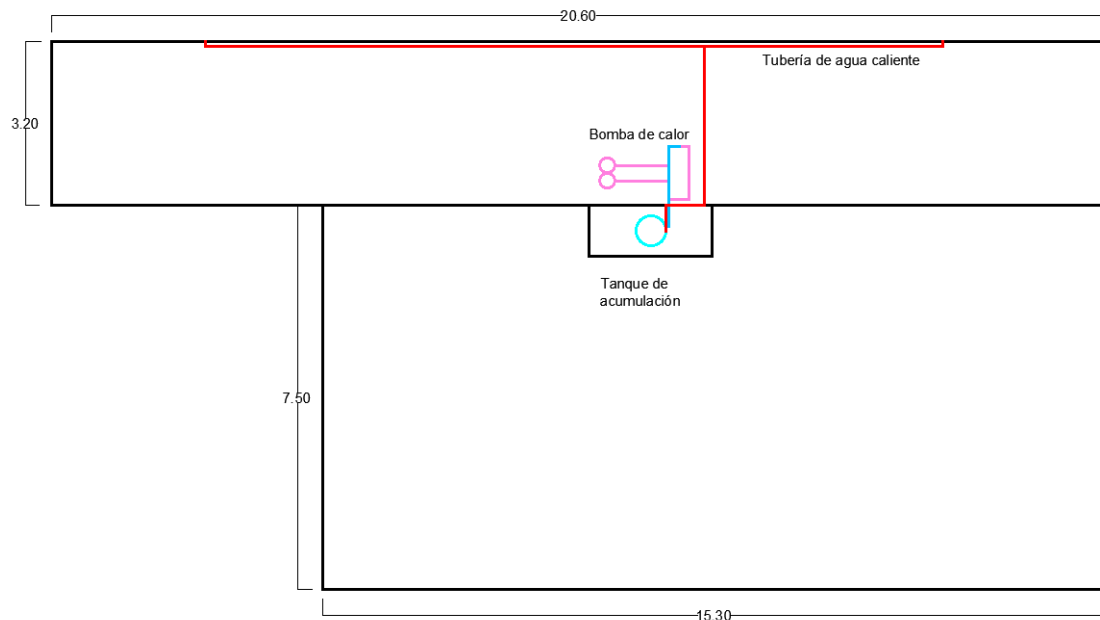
Vista en planta del techo y plano básico del espacio donde se diseñará la instalación.
